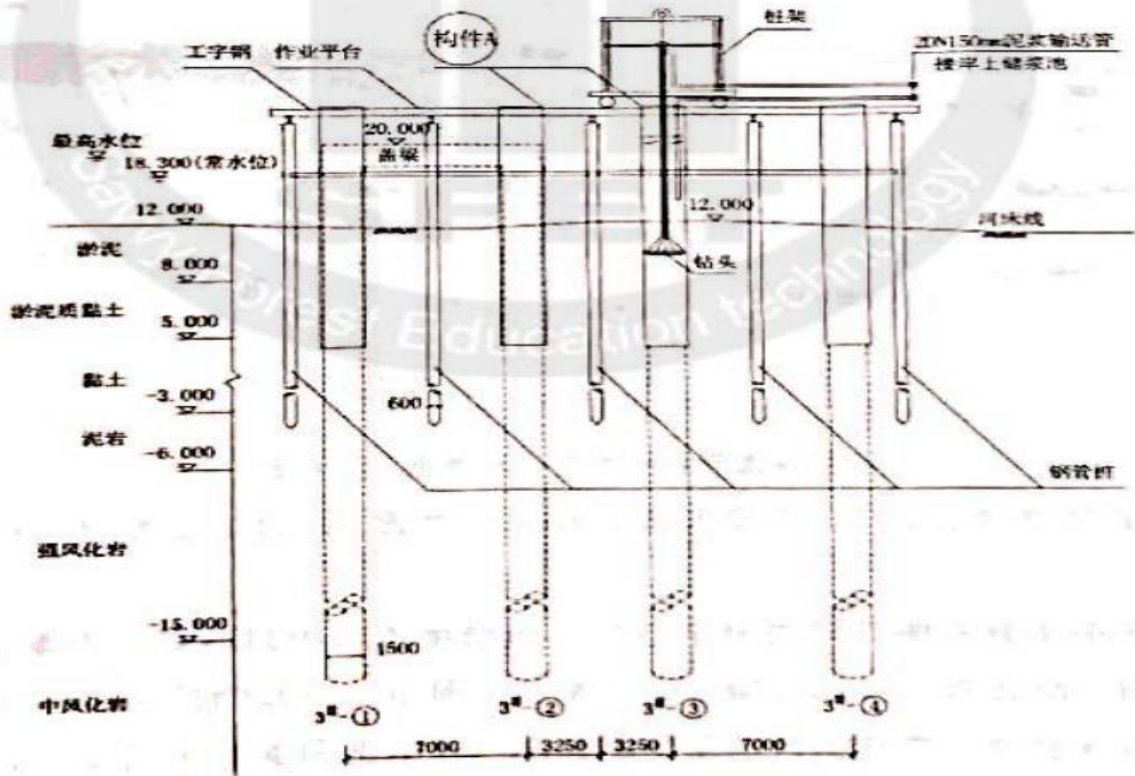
3#墩水上作业平台及桩基施工横断面布置示意图
